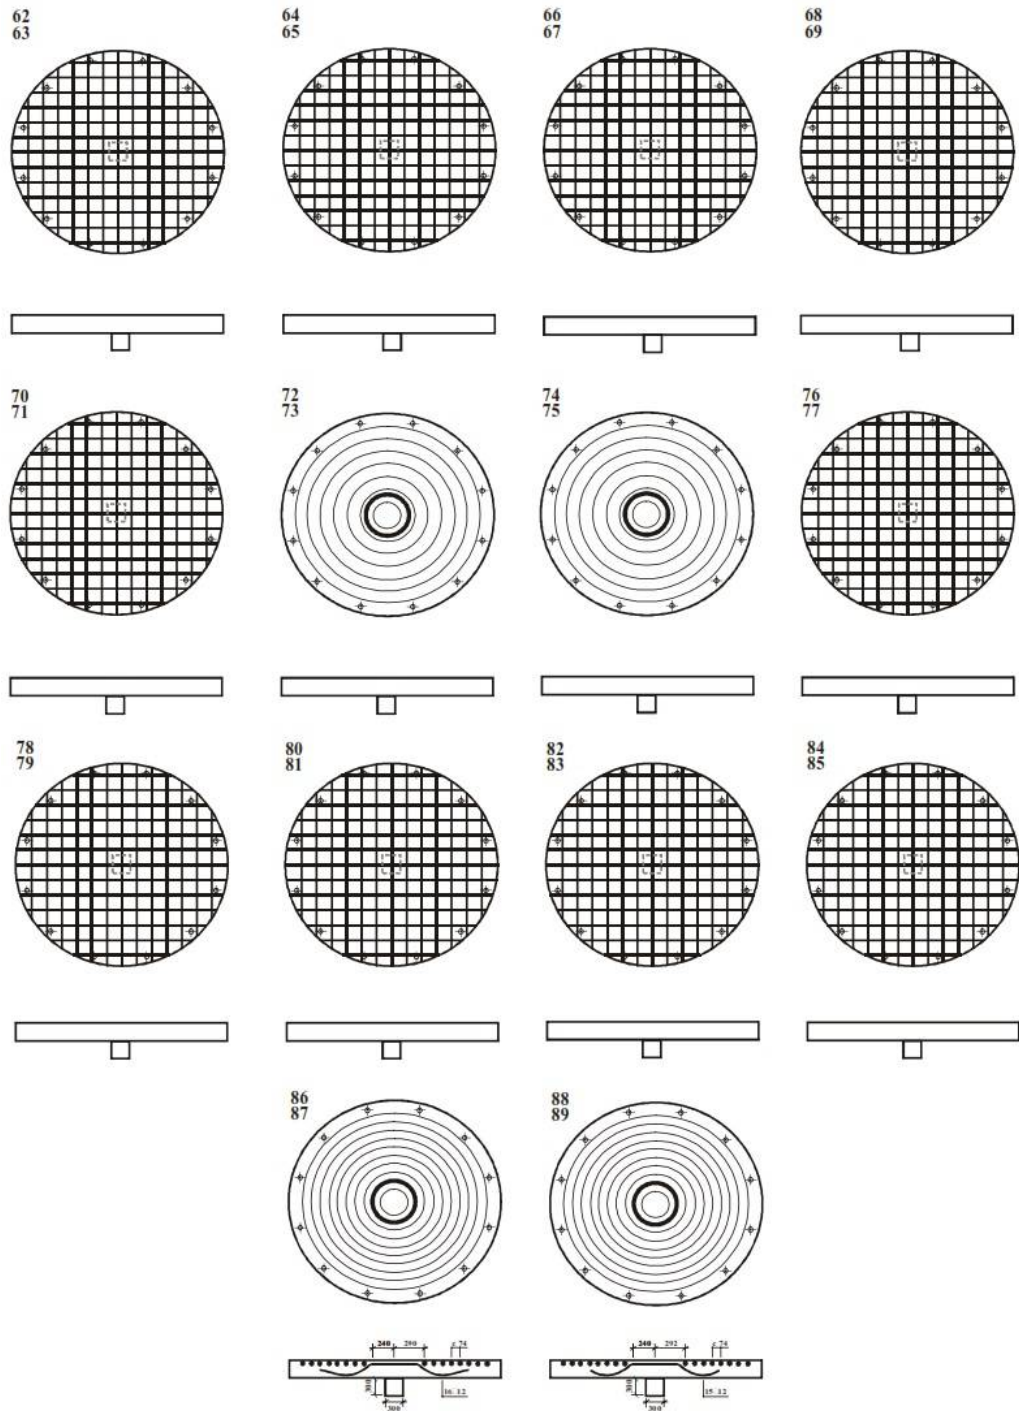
Pormenor das lajes ensaiadas por [4].
